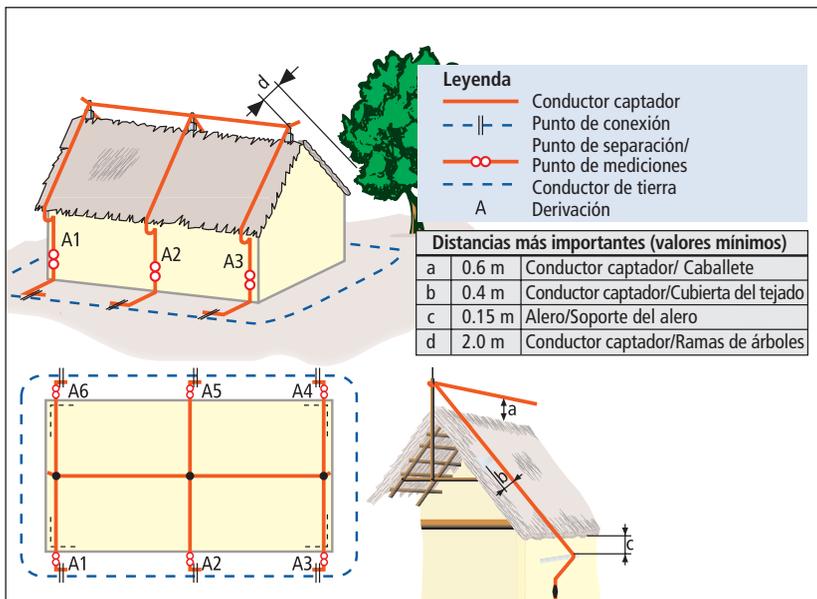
Instalación captadora para edificios con cubiertas de paja.
